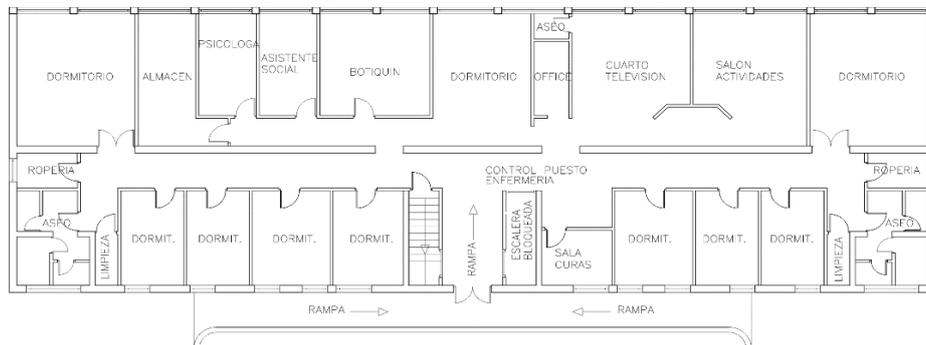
Planta Baja. Estado Actual.
